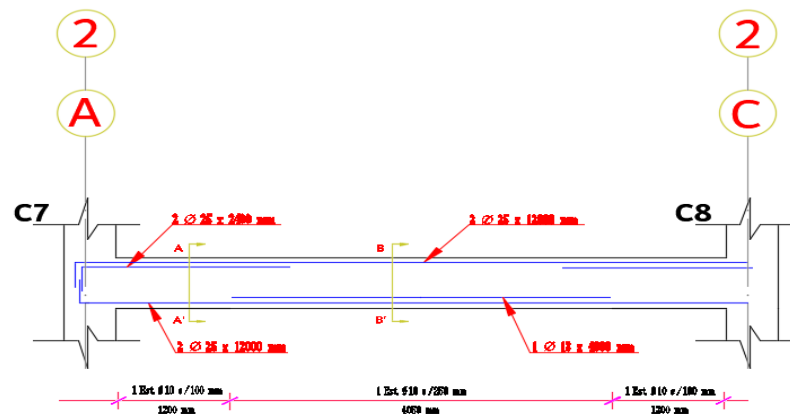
Detalle de viga principal eje "X" piso 4.
